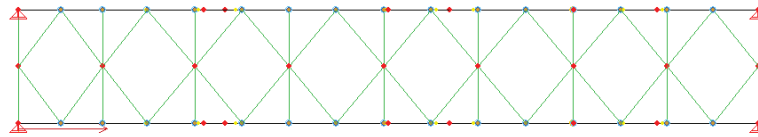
Vista in pianta impalcato con vincoli in estremità
